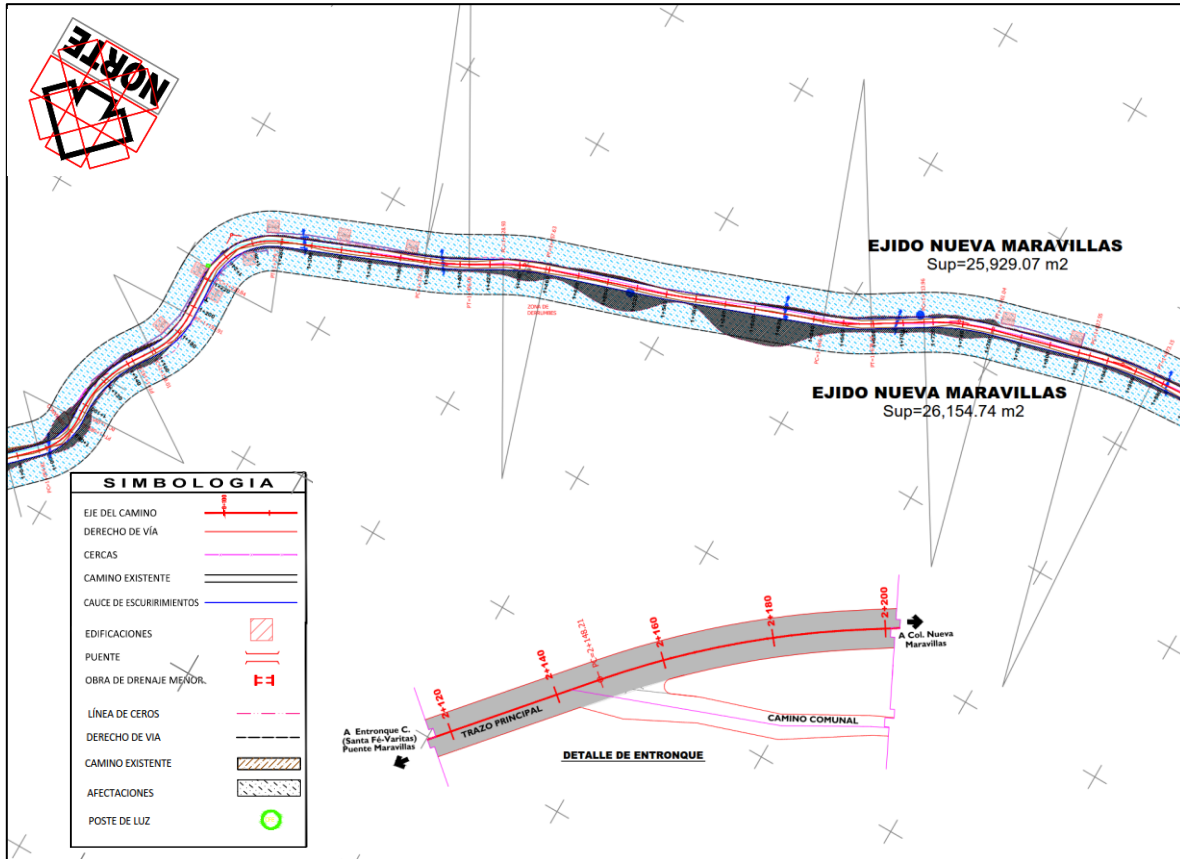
Planta general del proyecto y el entronque localizado en el Km 0+000.
